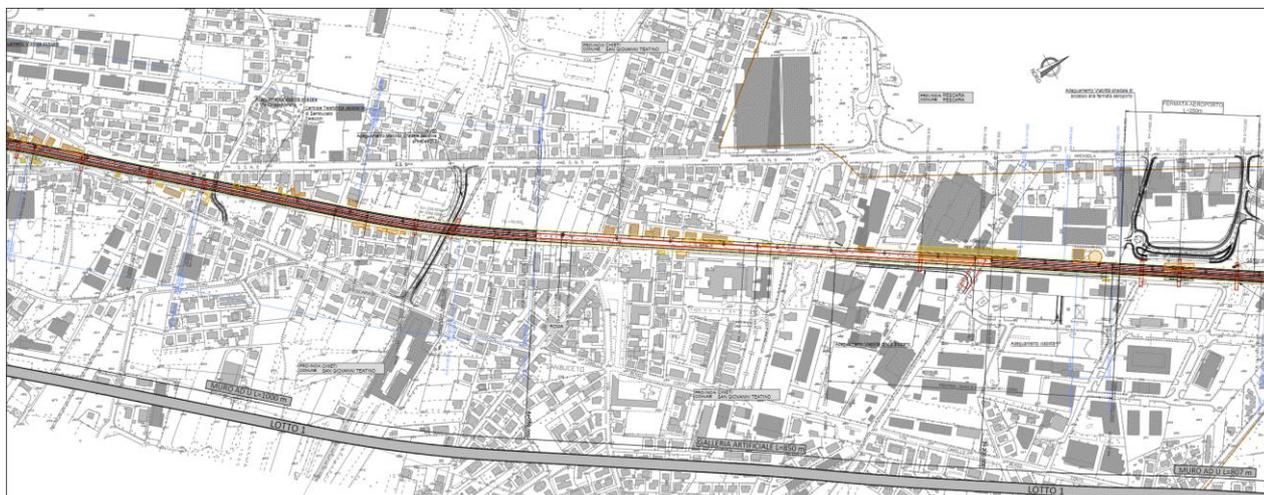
Planimetria raddoppio da pk 2+700 a pk 4+900
